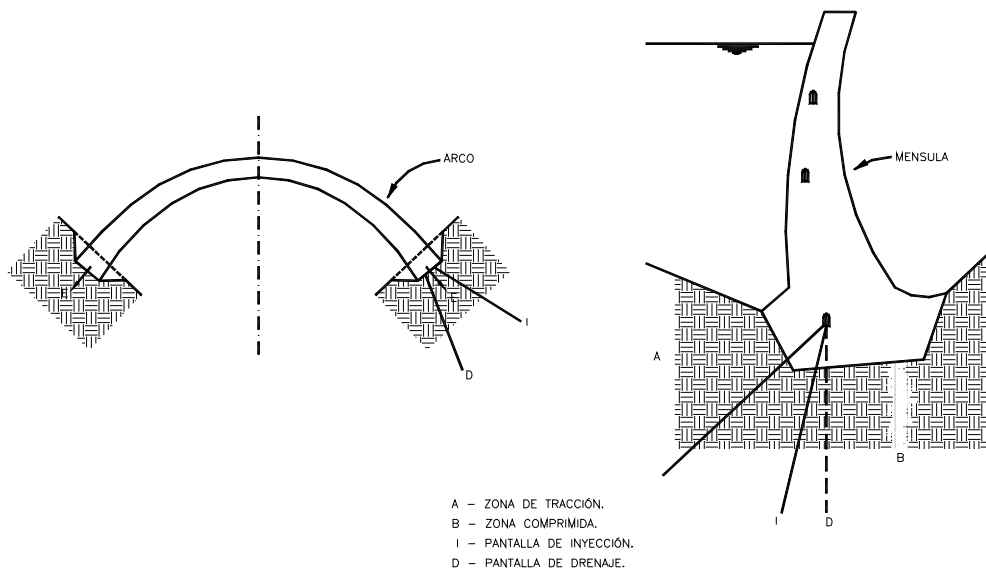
PANTALLA DE IMPERMEABILIZACION Y DRENAJE
